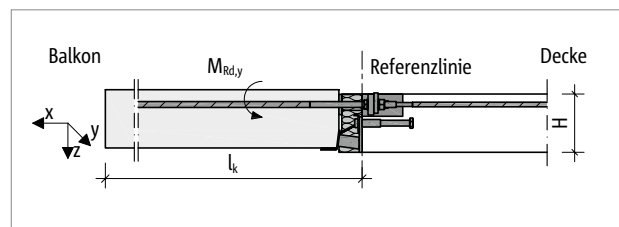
Schöck Isokorb® IQ Typ K-A: Statisches System
